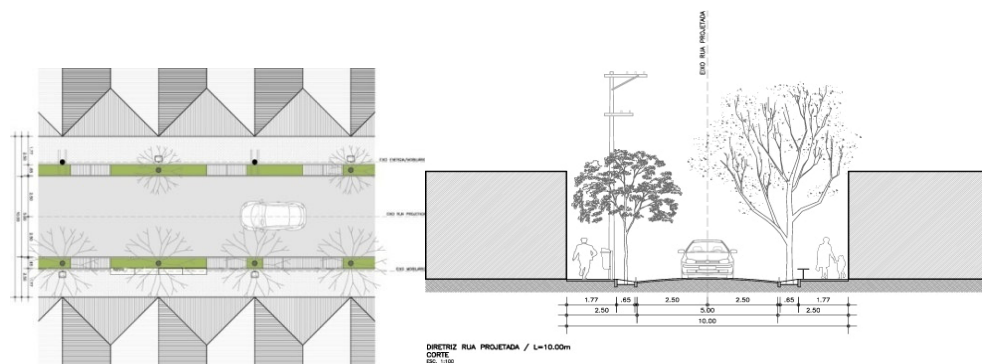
Alternativo situação 1, eixo de 10,00 m
